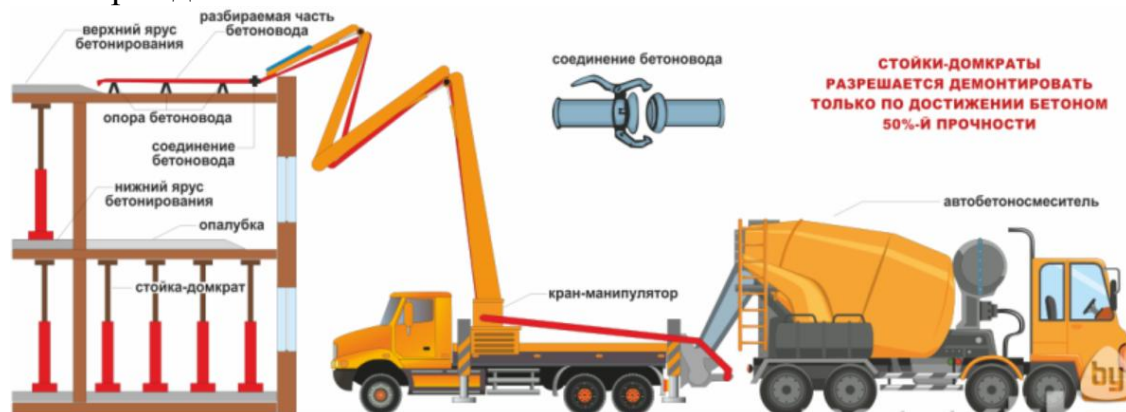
Безопасность при подаче бетонной смеси автобетононасосом
